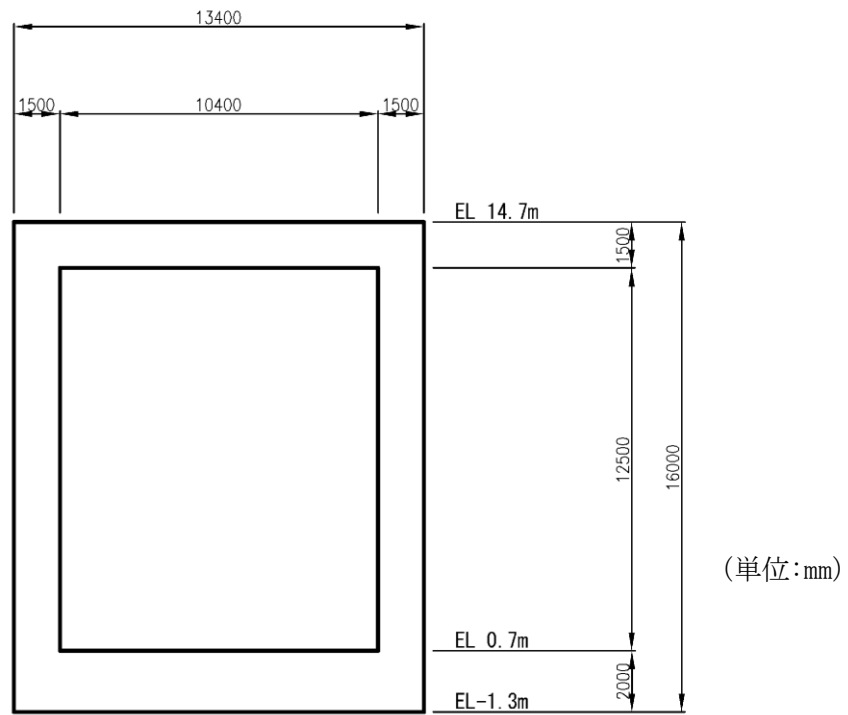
低圧原子炉代替注水ポンプ格納槽 断面図 (B-B断面)
